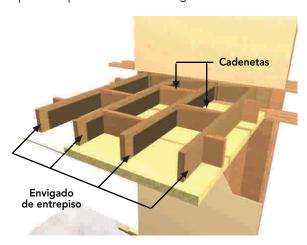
5: Piezas de madera dispuestas en forma normal, de sección similar a las vigas secundarias del entrepiso.
